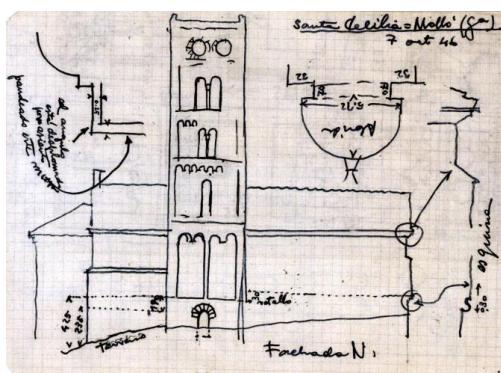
Molló. Iglesia de Santa Cecilia AAFV. Croquis fachada Norte
